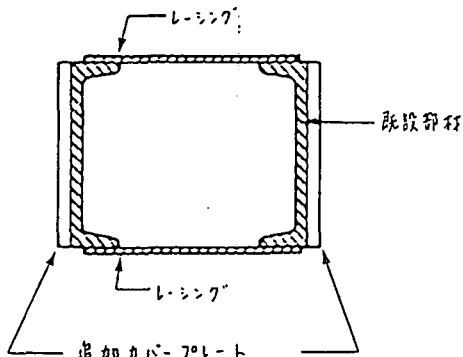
設計例（鋼カバープレートの追加によって補強される部材）
